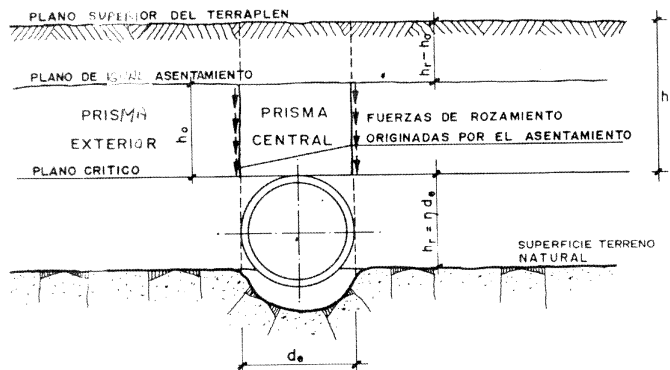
Esquema de la tubería colocada en zanja terraplenada.
